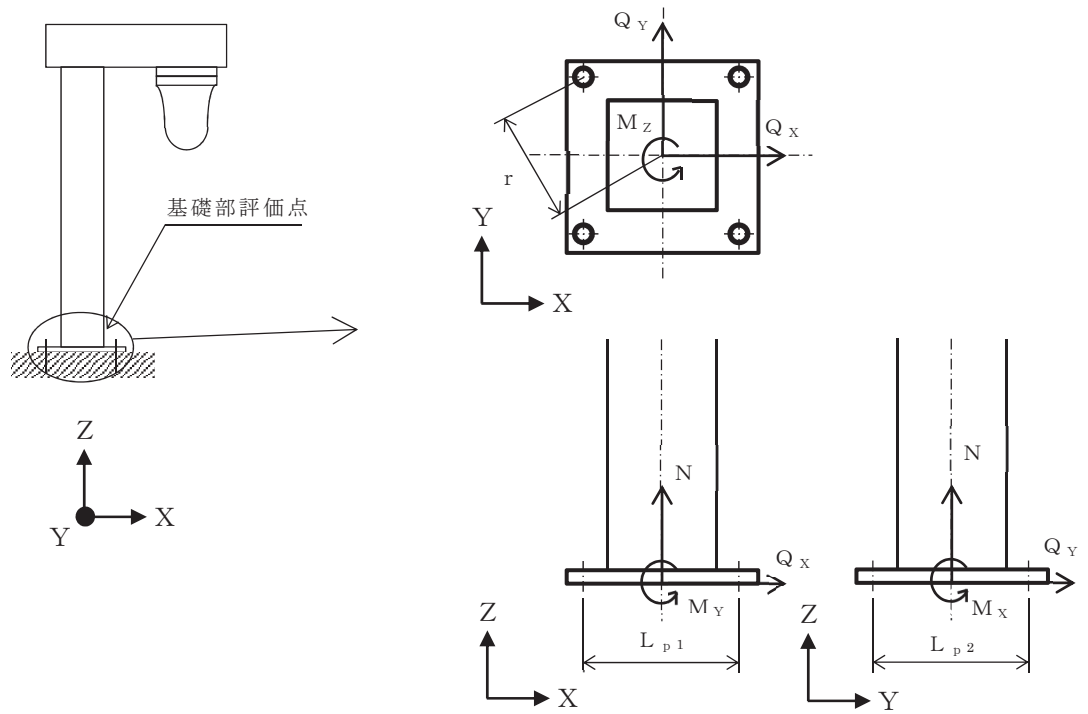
計算モデル（防潮堤 基礎ボルト）
